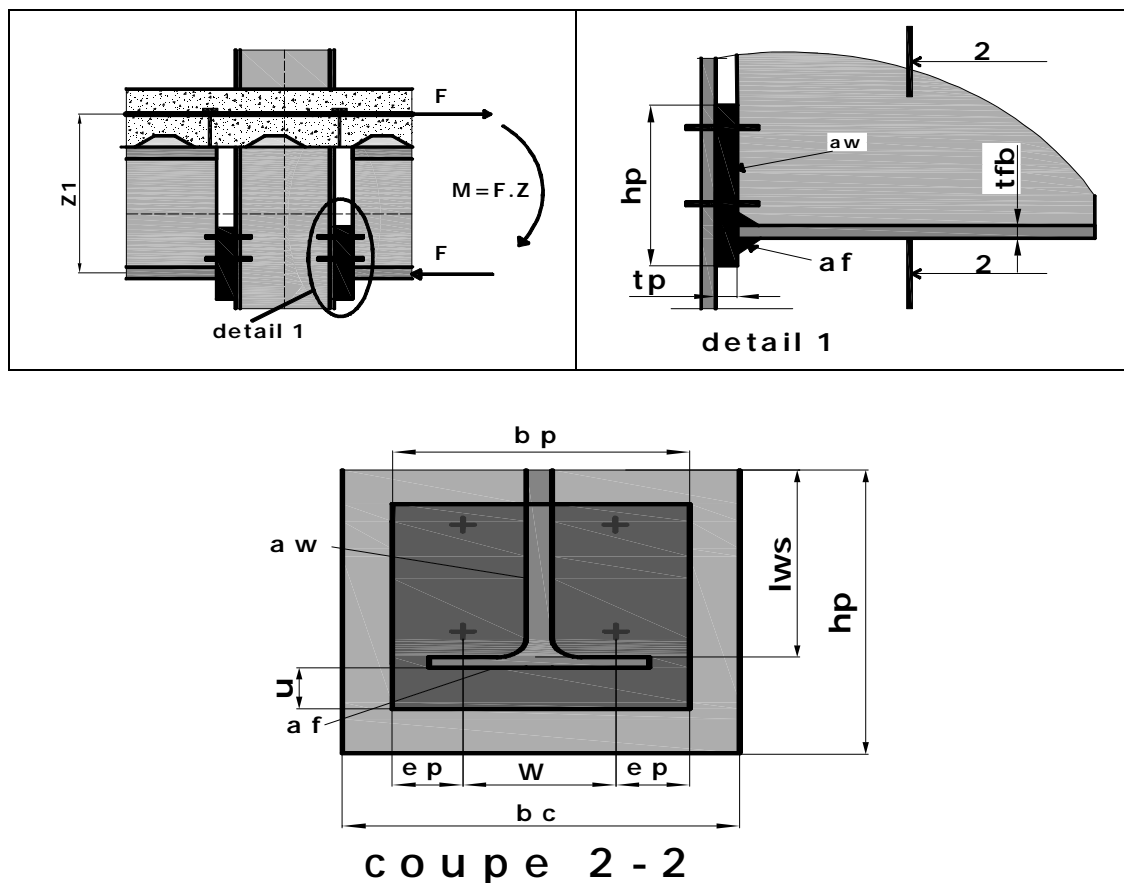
Caractéristiques géométriques d'un Assemblage poutre-poteau par platine d'extrémité de hauteur limitée
